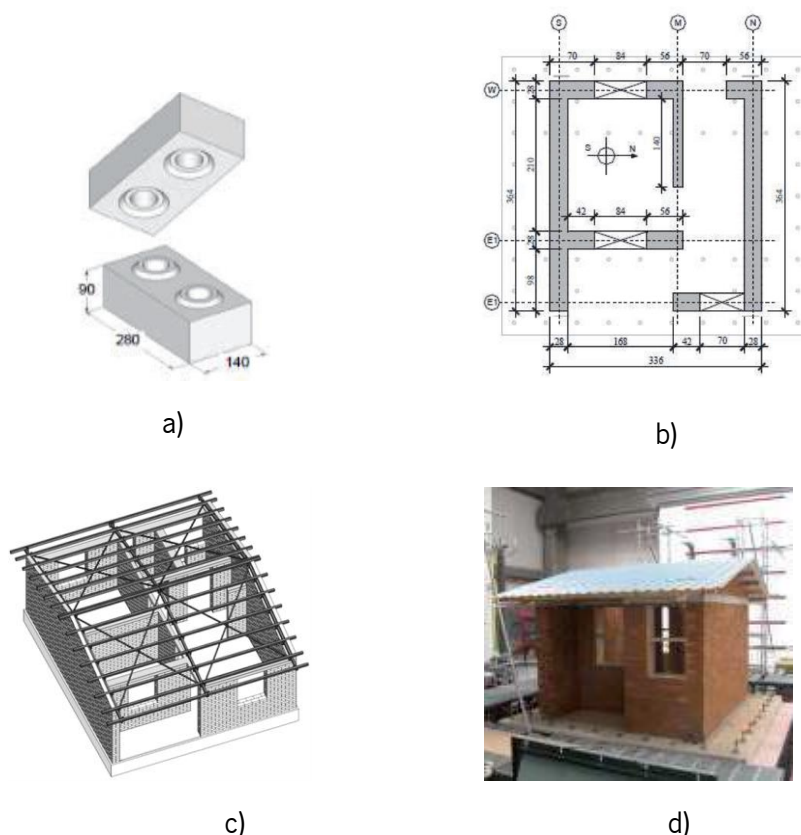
a) Bloco de terra compactada, b) planta estrutural, c) perspetiva do sistema estrutural, d) modelo da mesa sísmica terminado (Ramos et al., 2016)
